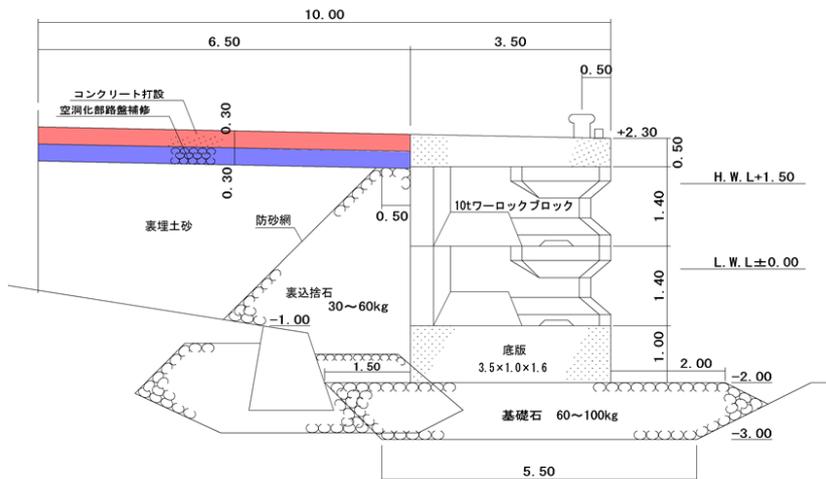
No.24 大洗港区_第1埠頭 C 物揚場 (-2.0m) の断面図 (復旧後)
